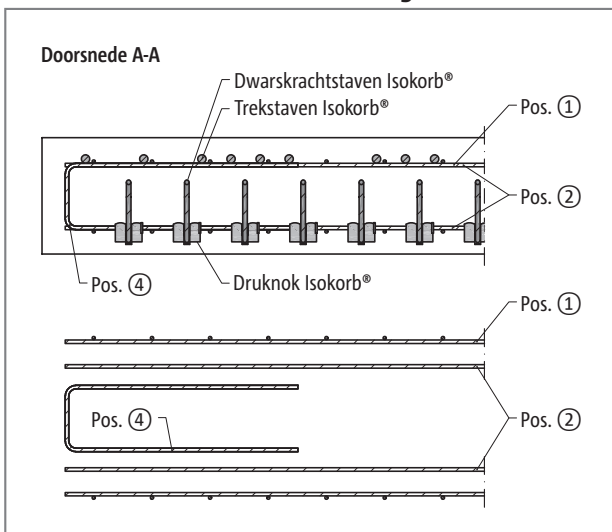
Schöck Isokorb® CT type K-T: bijlegwapening bij directe ondersteuning
